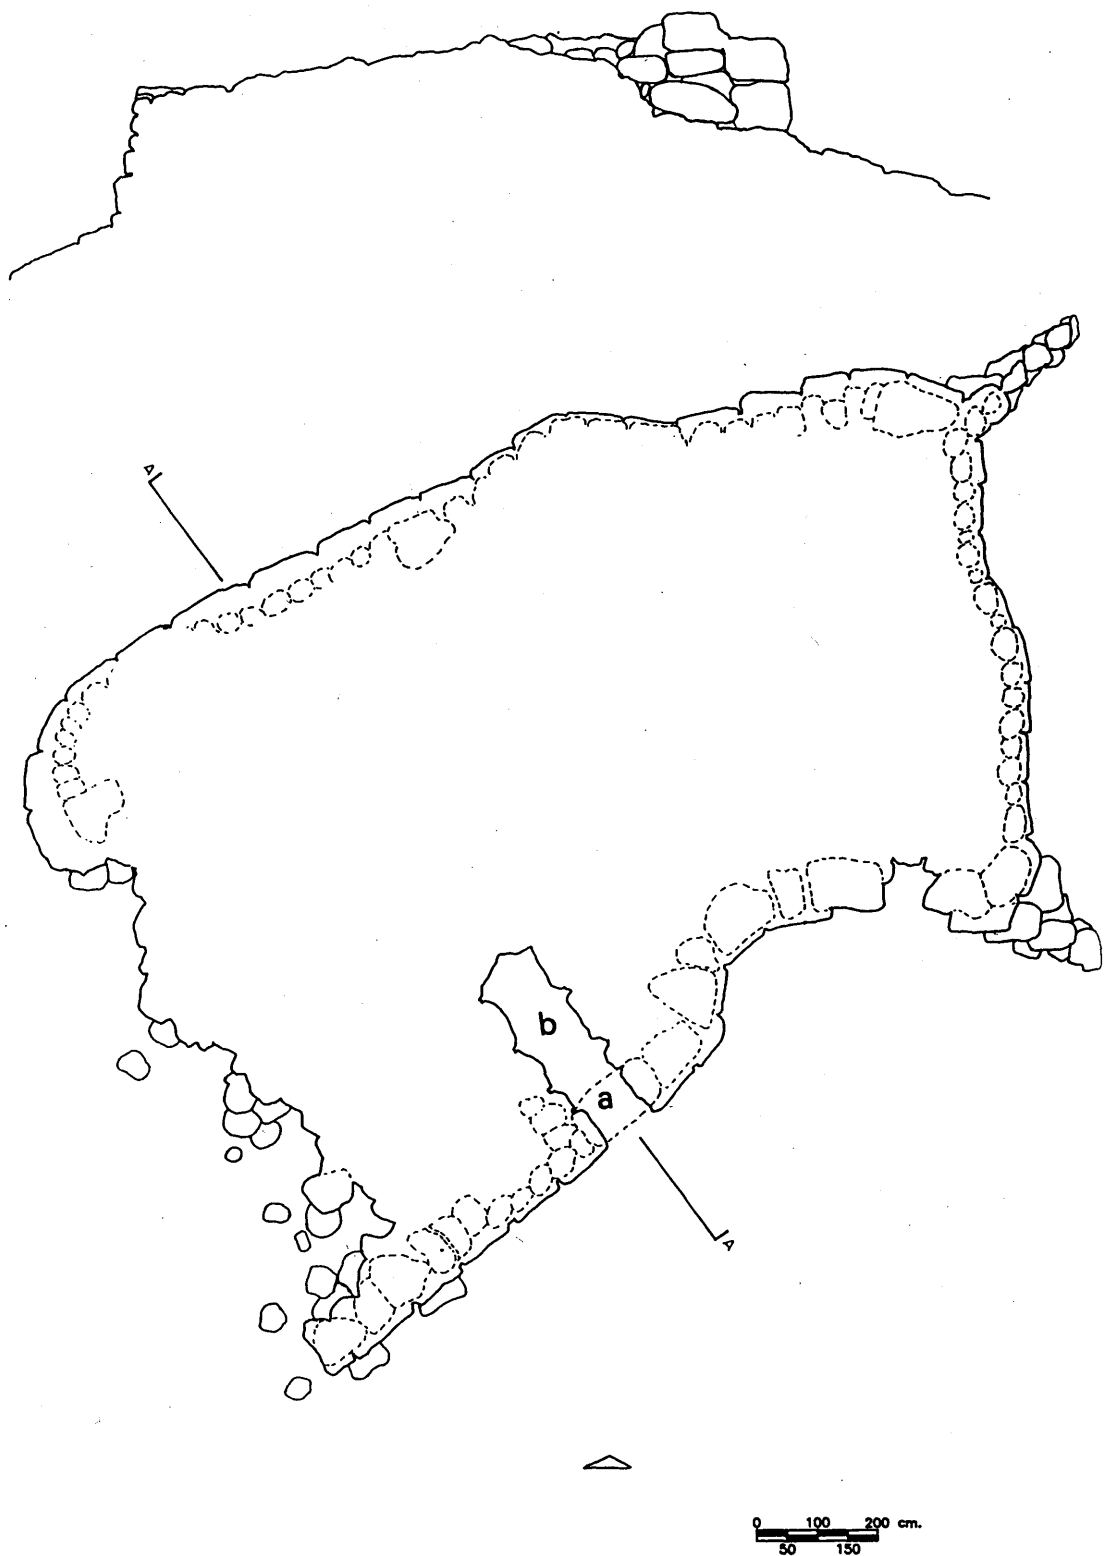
Nuraghe Pizzinnu: sezione e planimetria
